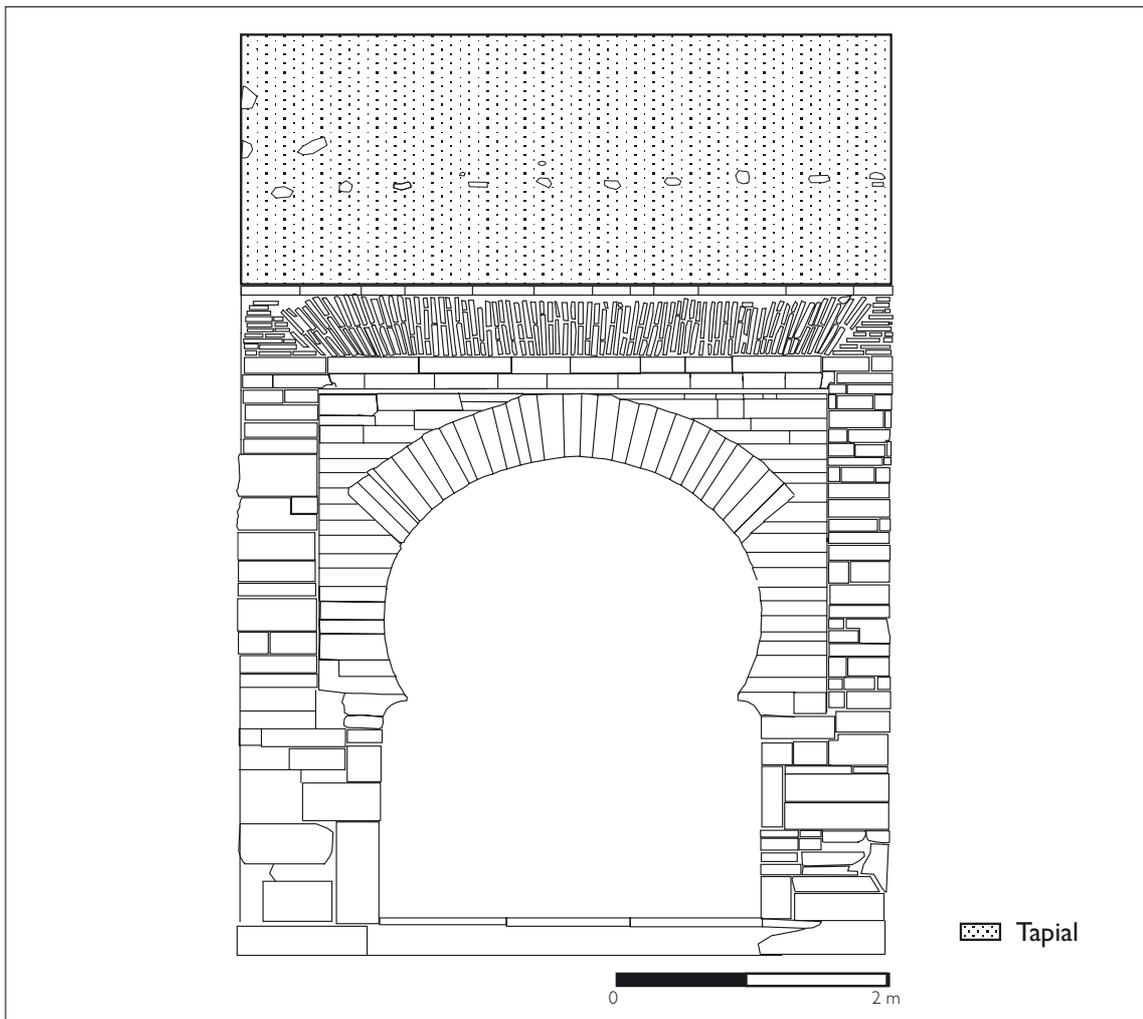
Planta de la Puerta Monaita (según el informe realizado de la actuación arqueológica de apoyo a la restauración de la Puerta).
